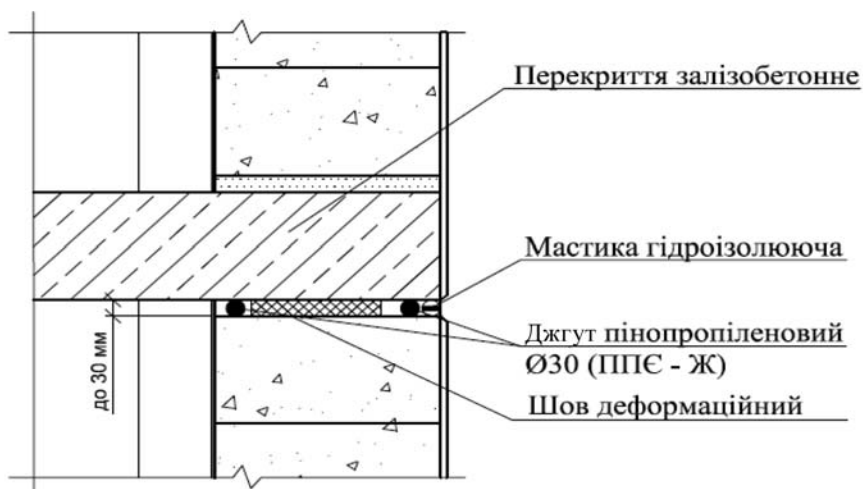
Схема влаштування верхнього краю кладки в місці її прилягання до монолітного перекриття
